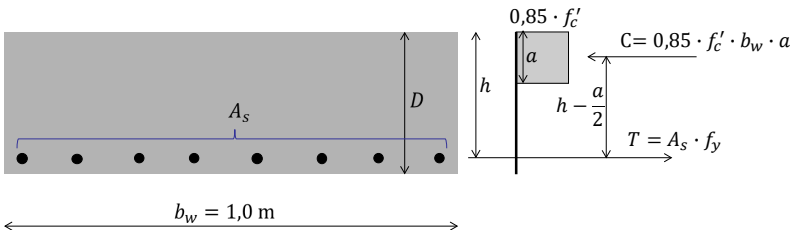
Esquema esfuerzos internos en zapata corrida de hormigón armado
